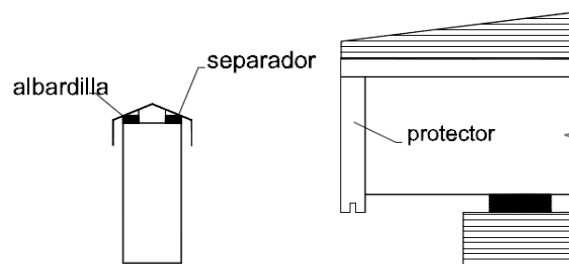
Ejemplo de protección de elementos estructurales situados al exterior.
